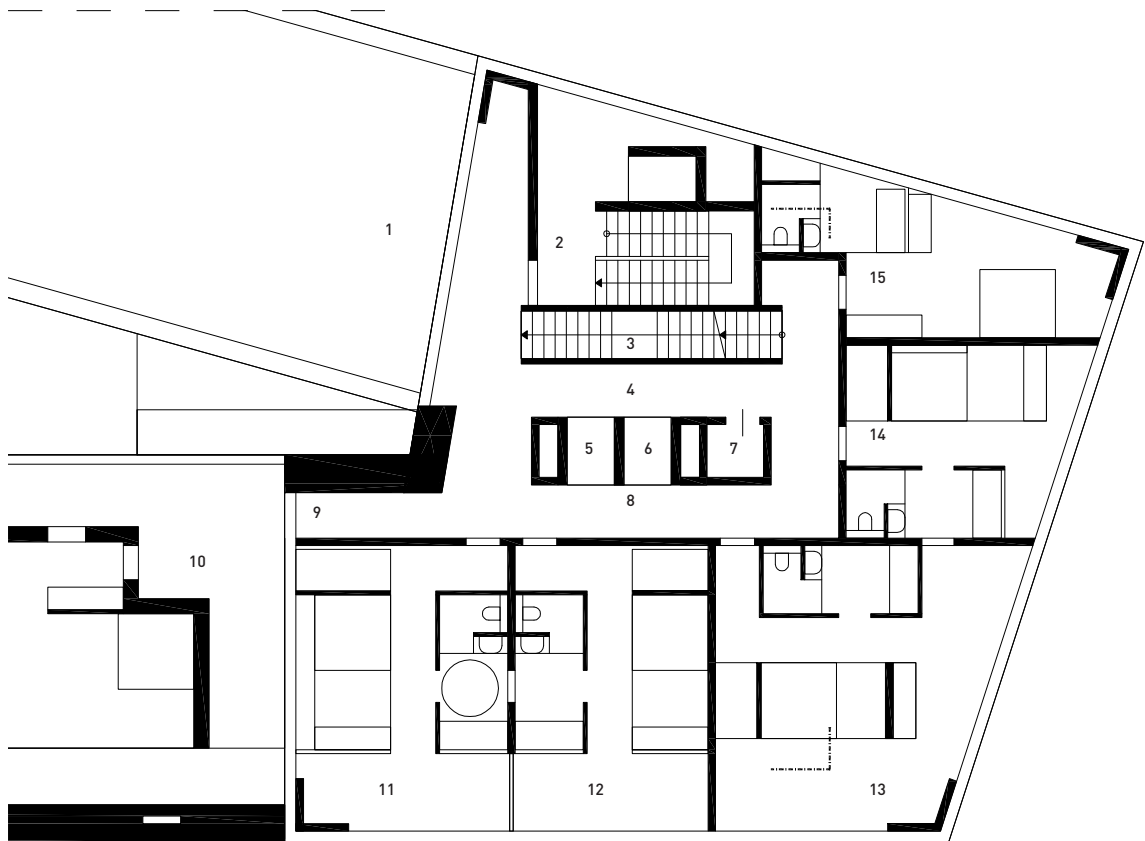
Grundriss Unterkunft Zimmer M1:200
